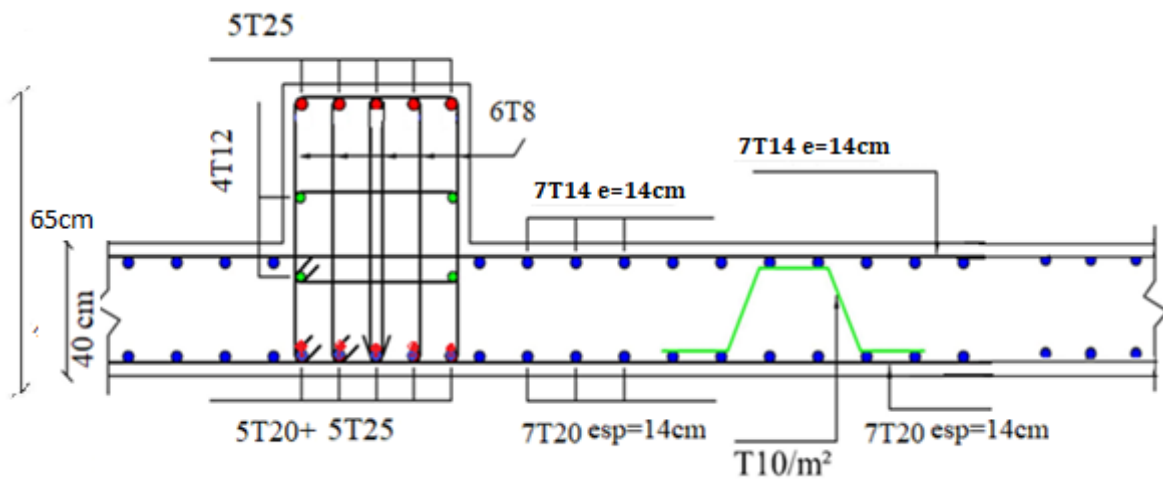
ferrailage de la dalle du radier et la nervure en travée
